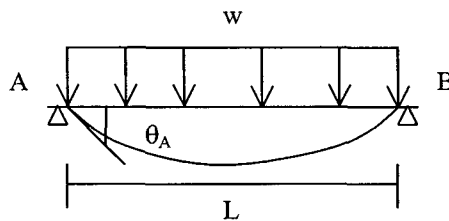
Rotação no apoio A de uma viga simplesmente apoiada.
